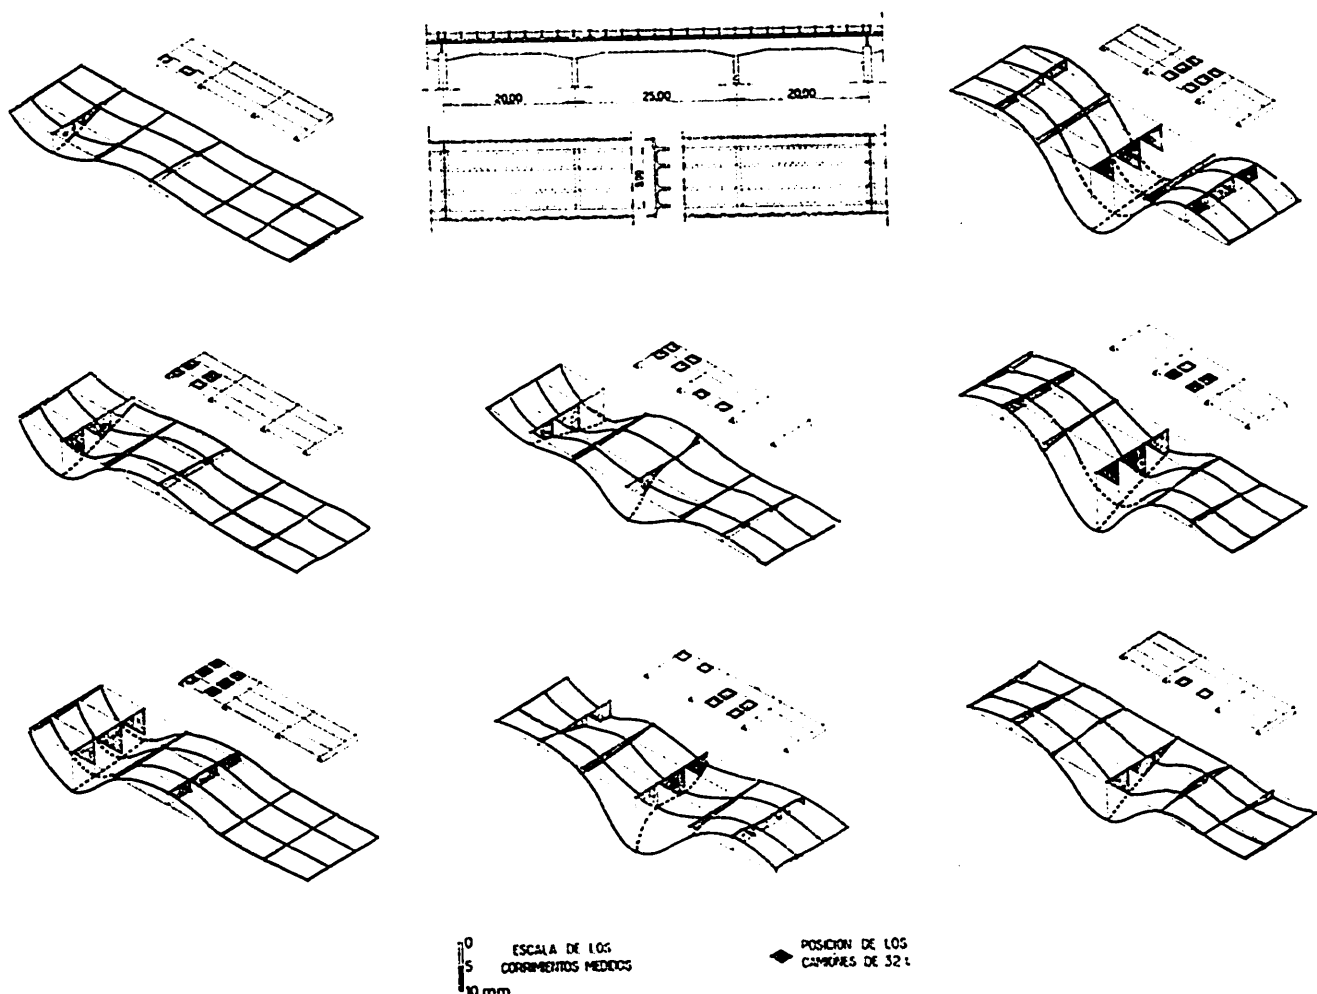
Flechas de las vigas continuas de hormigón (puente de Vila Franca).
